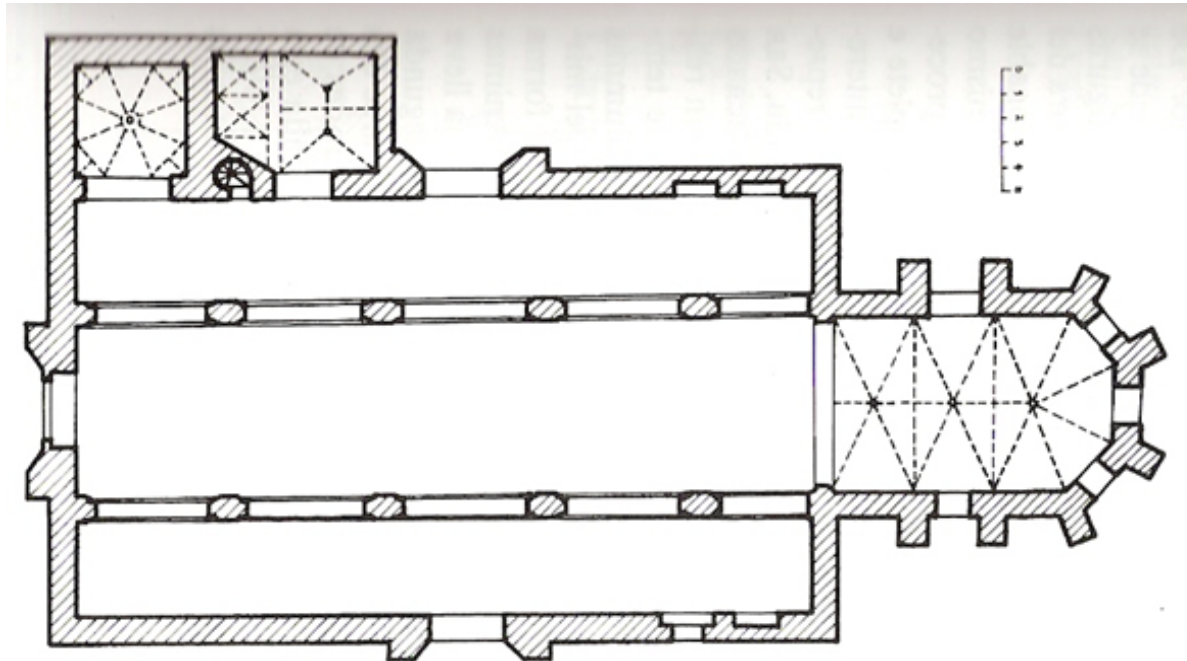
Grundriss, Kirche Omnium Sanctorum, Sevilla.
